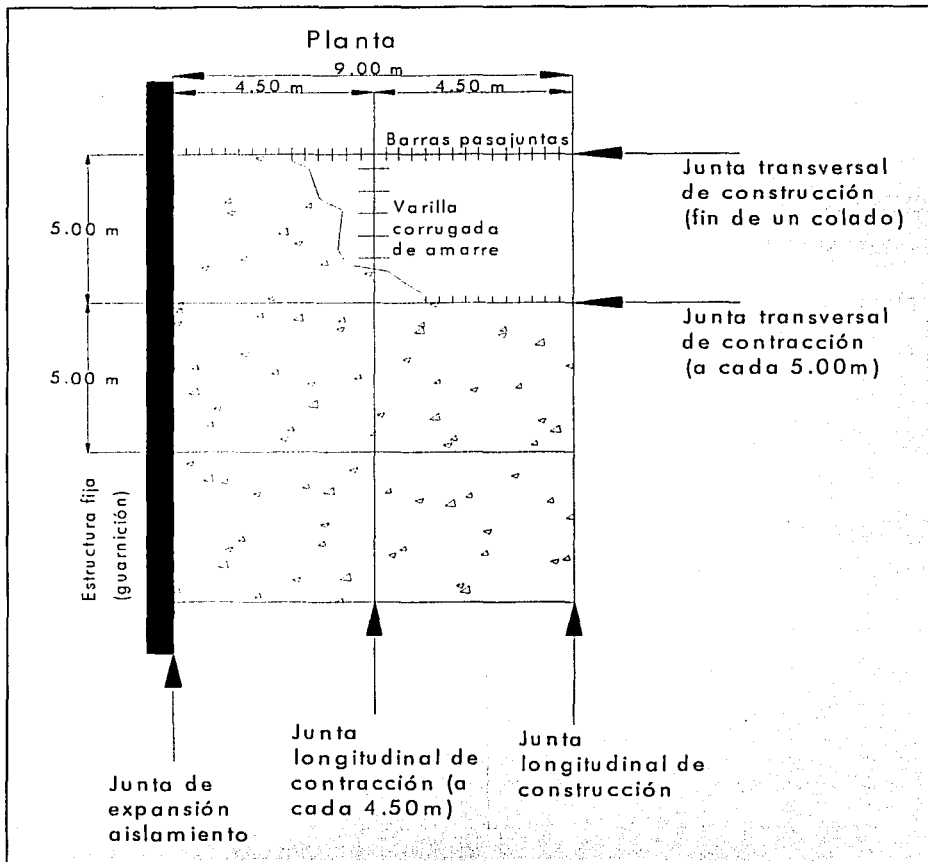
Tipos de juntas que existen en un pavimento de concreto.
